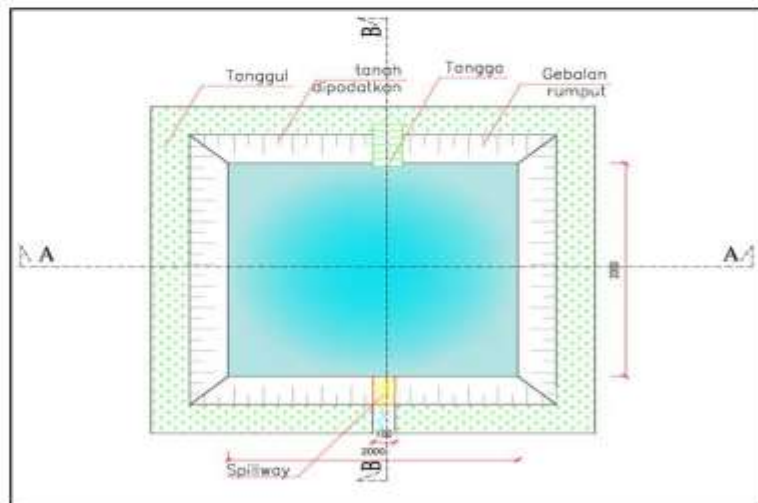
Detail tanggul keliling, tangga dan *inlet* air dari kolam retensi/embung dengan bahan spesi batu
